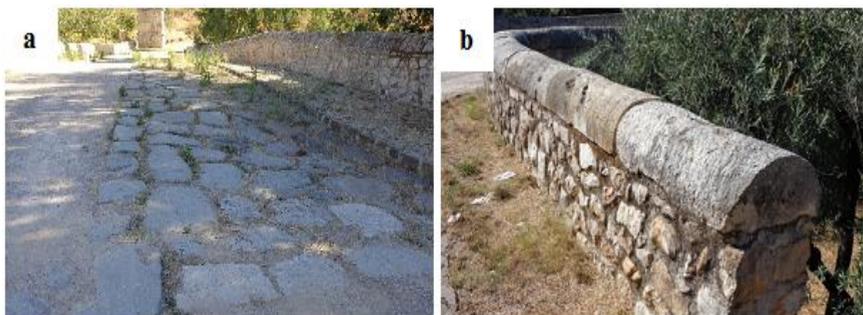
(a) Pavimentazione originaria del ponte e (b) parapetti con guide lapidee romane ricollocate.
